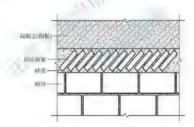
墙体顶部与梁之间的缝隙采用混凝土配套实心砖斜砌面紧
